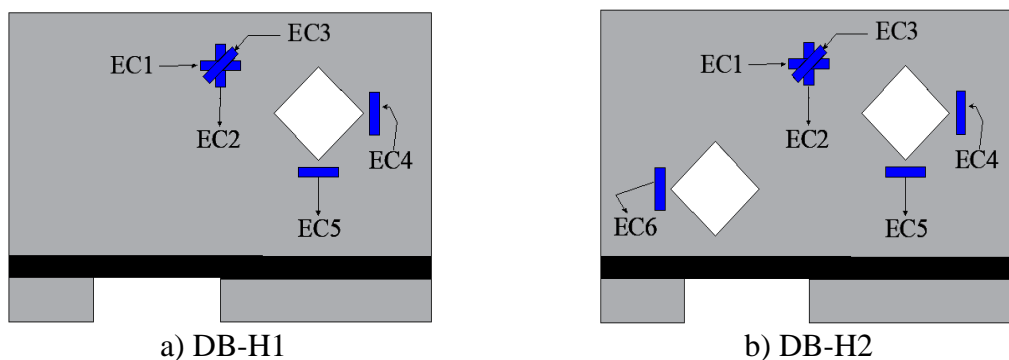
Posição dos extensômetros no concreto das vigas-parede reforçadas a flexão
